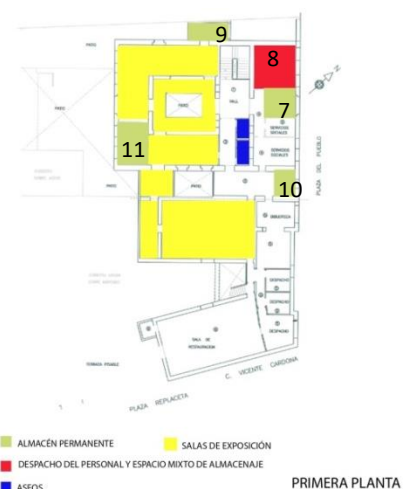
Plano del M.M.C.P. con las salas de almacenaje de la primera planta destacadas en color verde.
